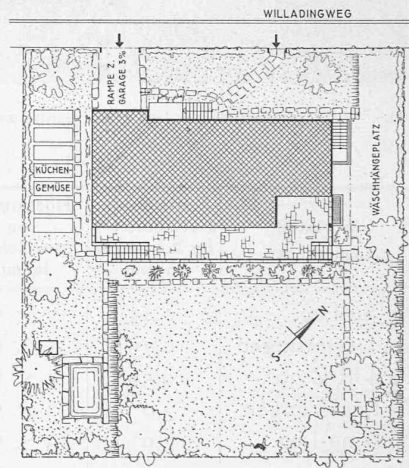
Lageplan des Hauses Chervet. — 1 : 500.
